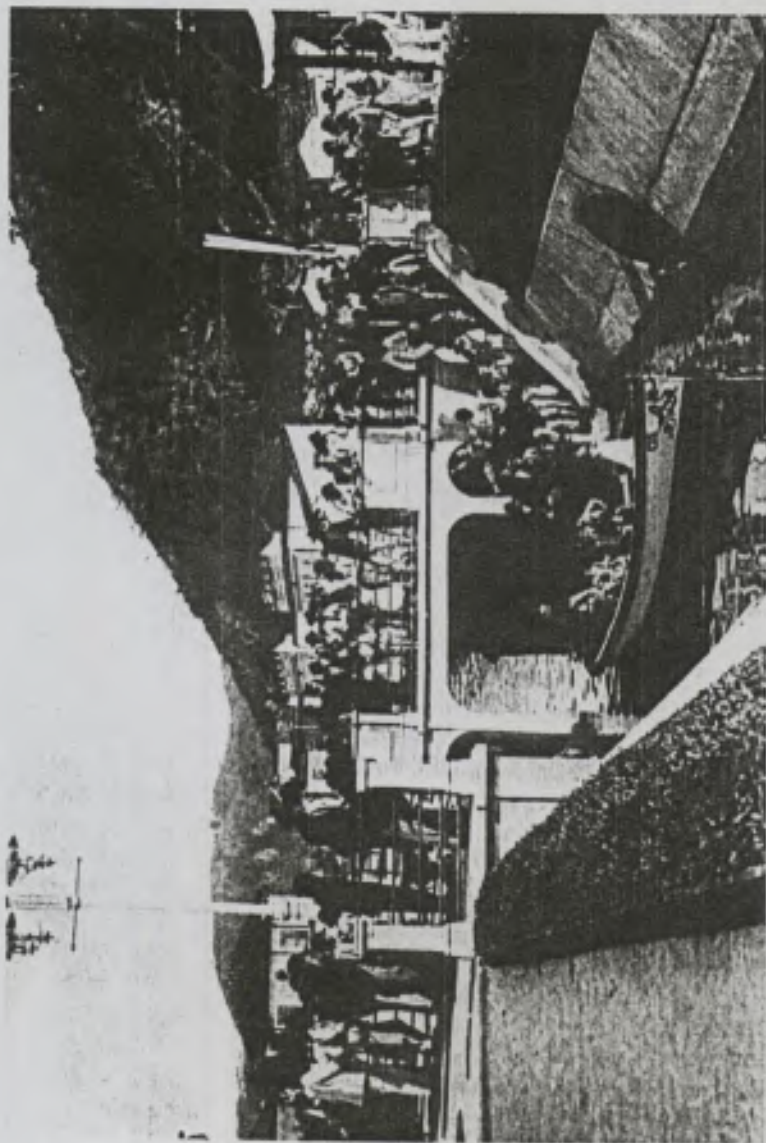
Saneamento em Santiago: ponte na Rua Brás Cubas (concreto armado)
